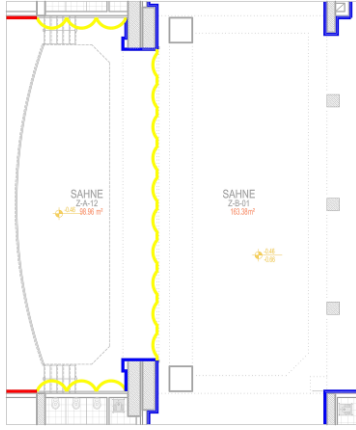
Salon içerisinde kullanılması önerilen malzemelerin yerleşimi, plan (Recommended materials placement in the hall, plan)
